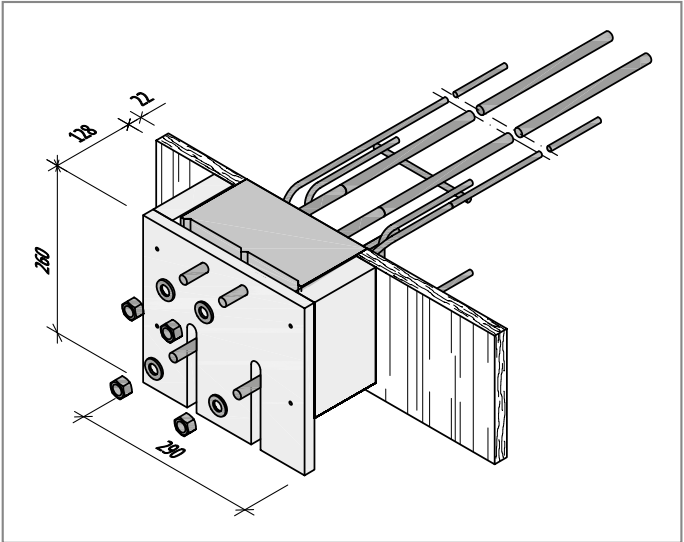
Schöck Isokorb® XT Typ SK: Darstellung mit Einbauhilfe
